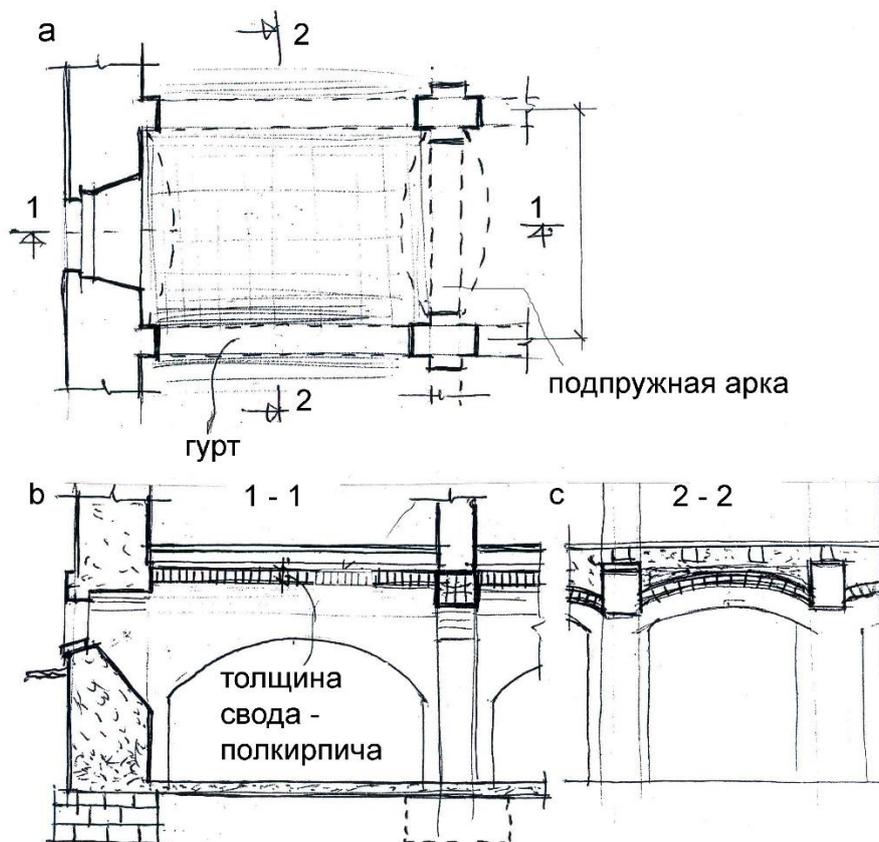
Прусский свод в перекрытии подвала: а – план; б – разрез по линии щельги свода; с – разрез по линии кривизны свода [32]
